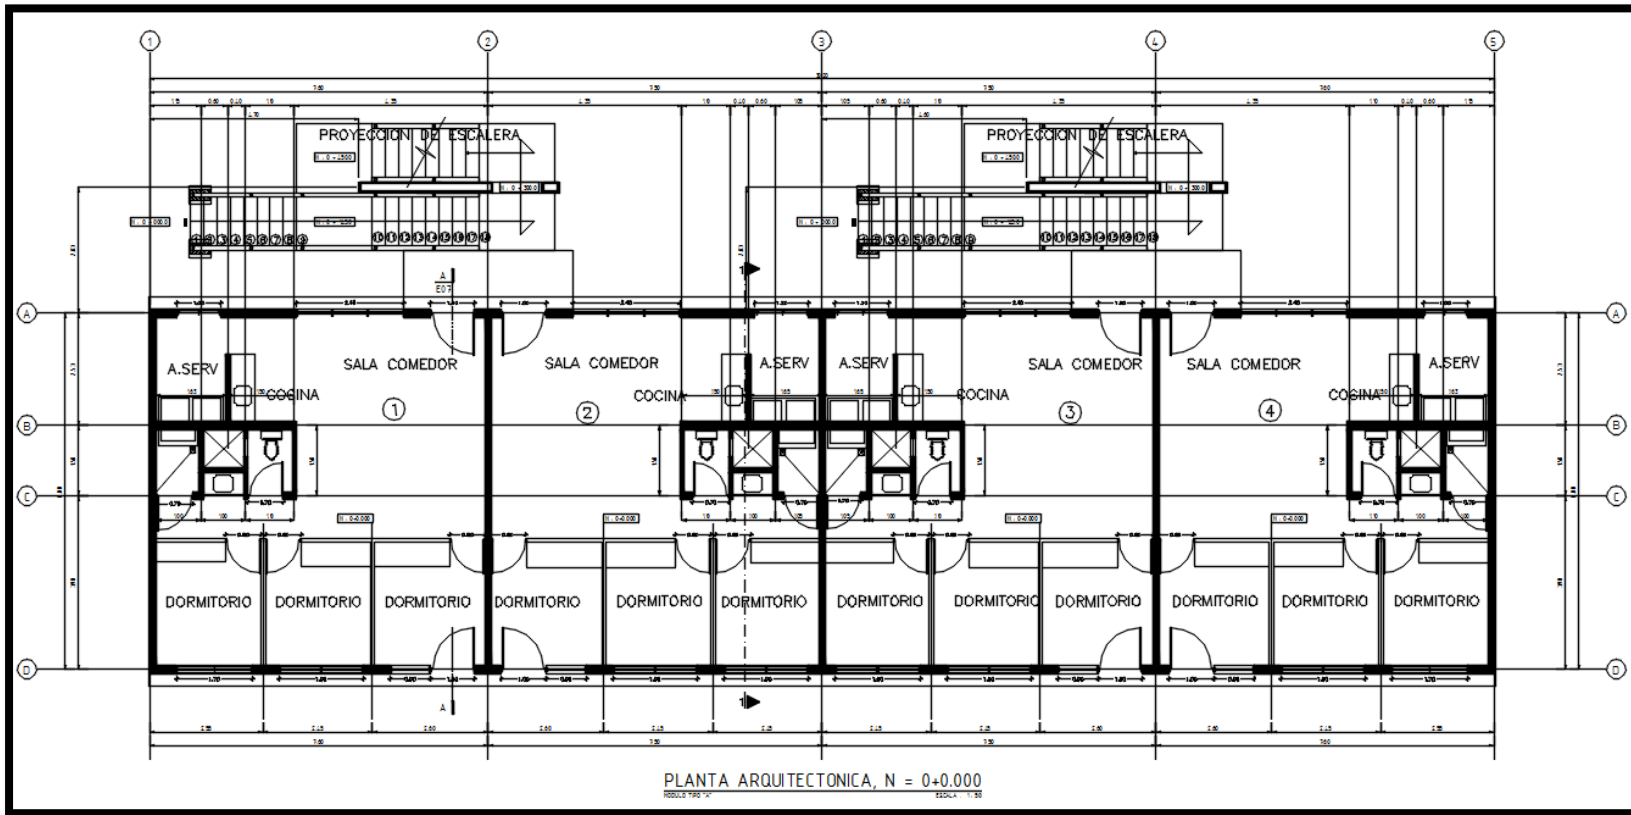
Planta Arquitectónica (Elevación 0 + 0.000)
